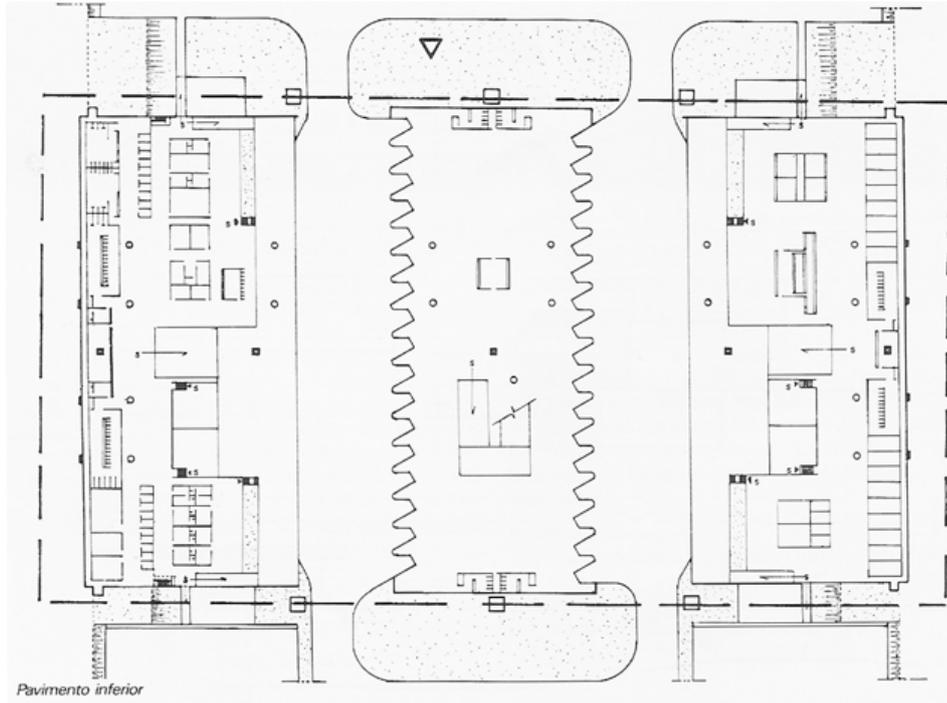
Planta Baixa do Pavimento Inferior – Portal Goiânia
